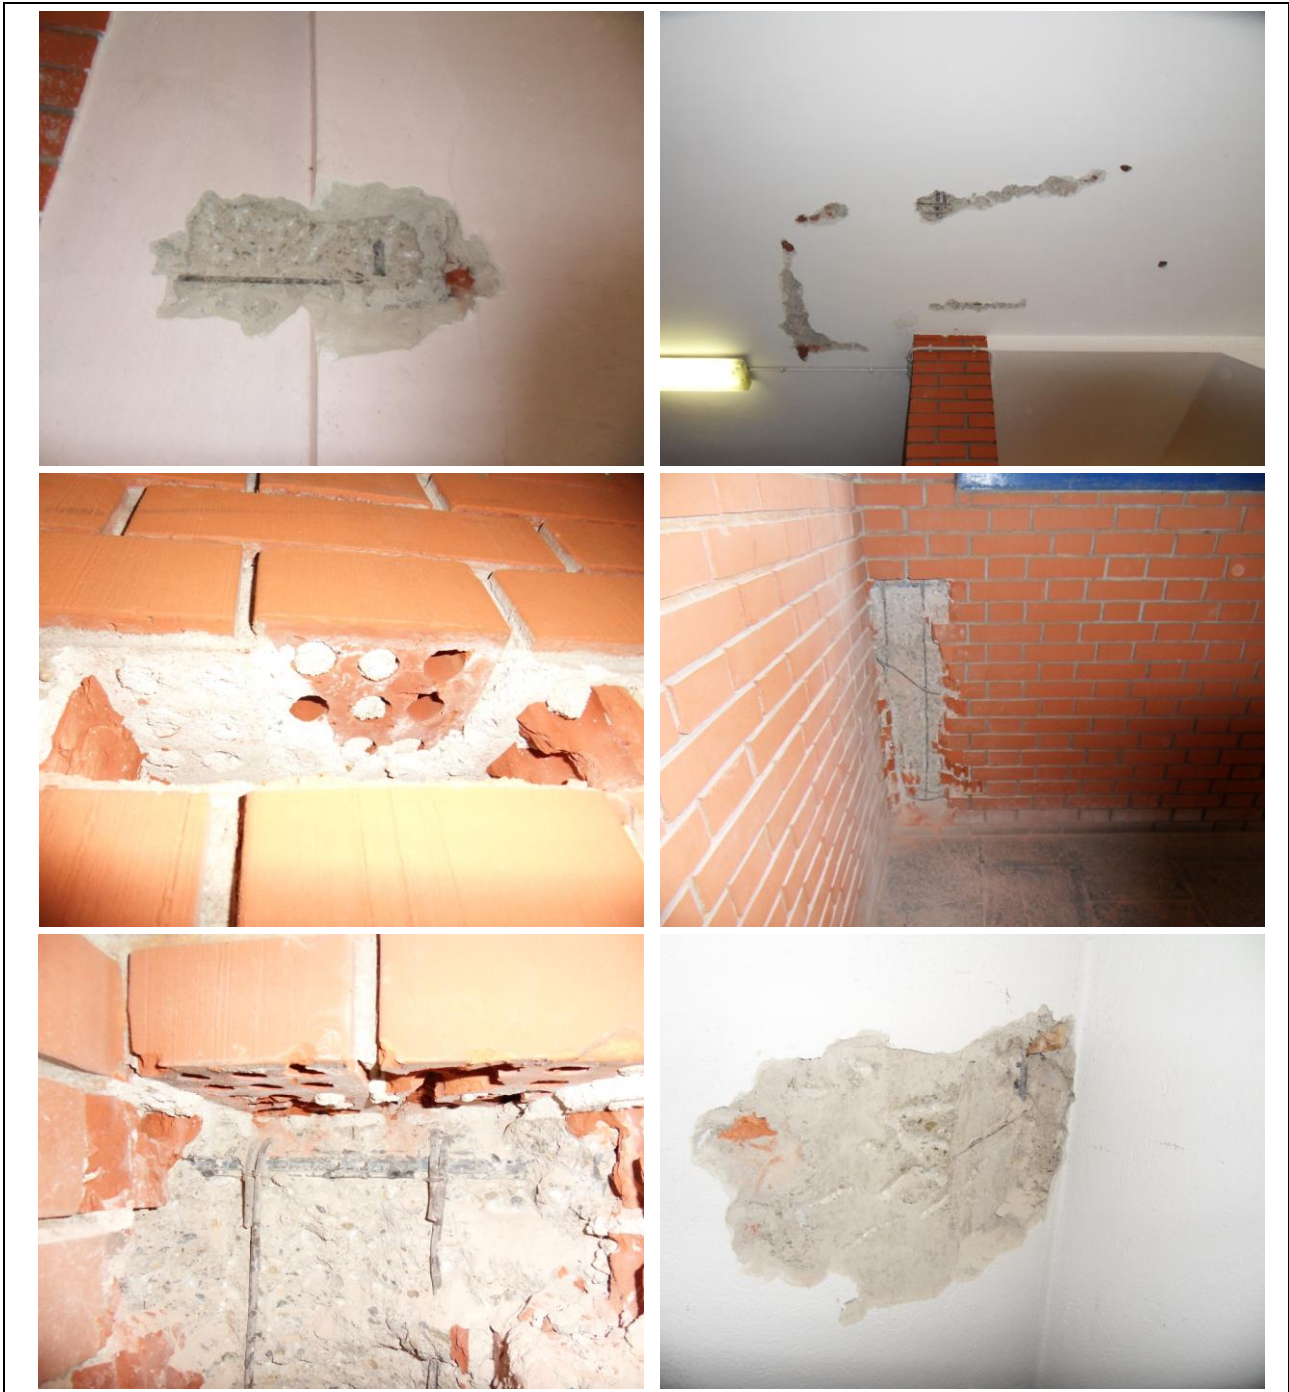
Assaggi sulle strutture esistenti piano terra e solaio piano primo
